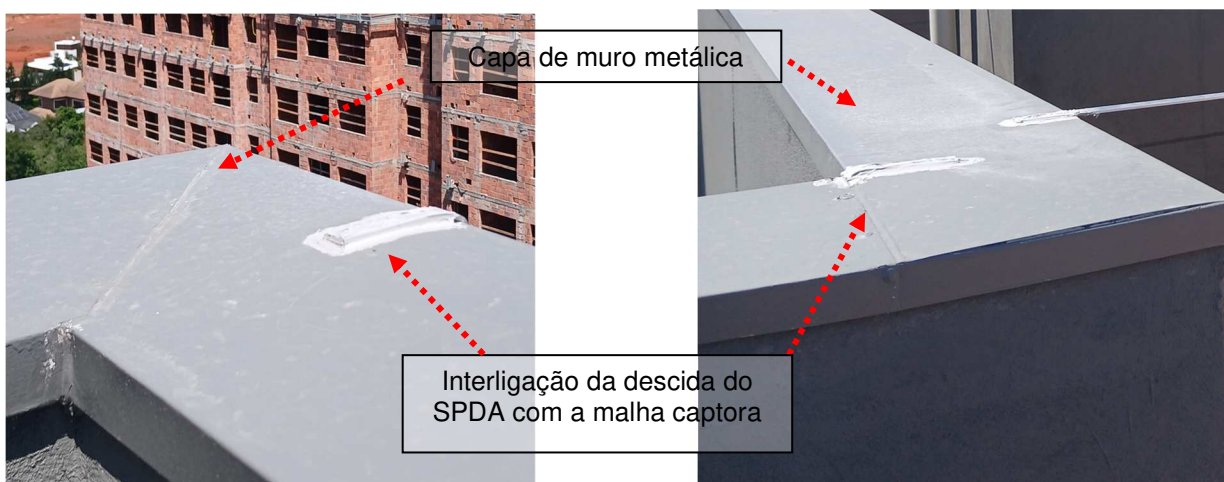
e 54: Malha captora natural e elementos metálicos em cota mais baixa da cobertura da instalação.
